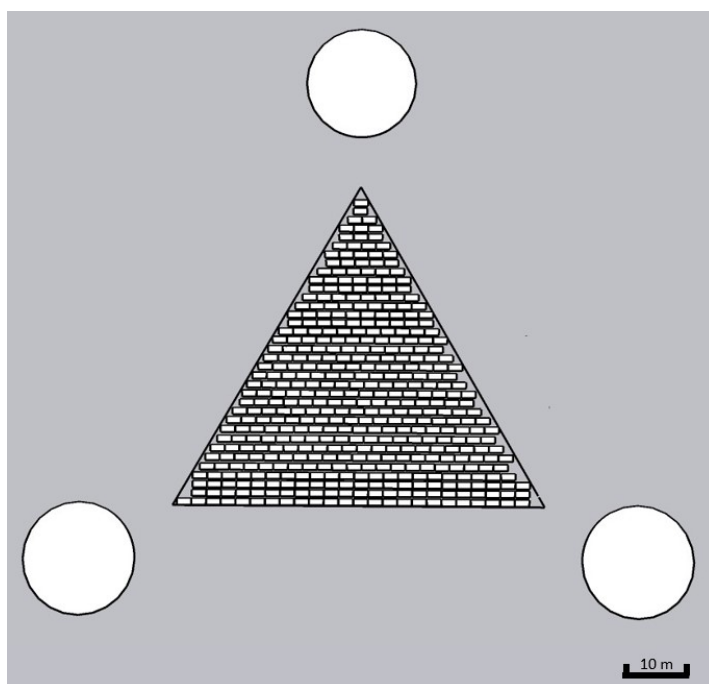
Localização 2, posicionamento horizontal de painéis.
